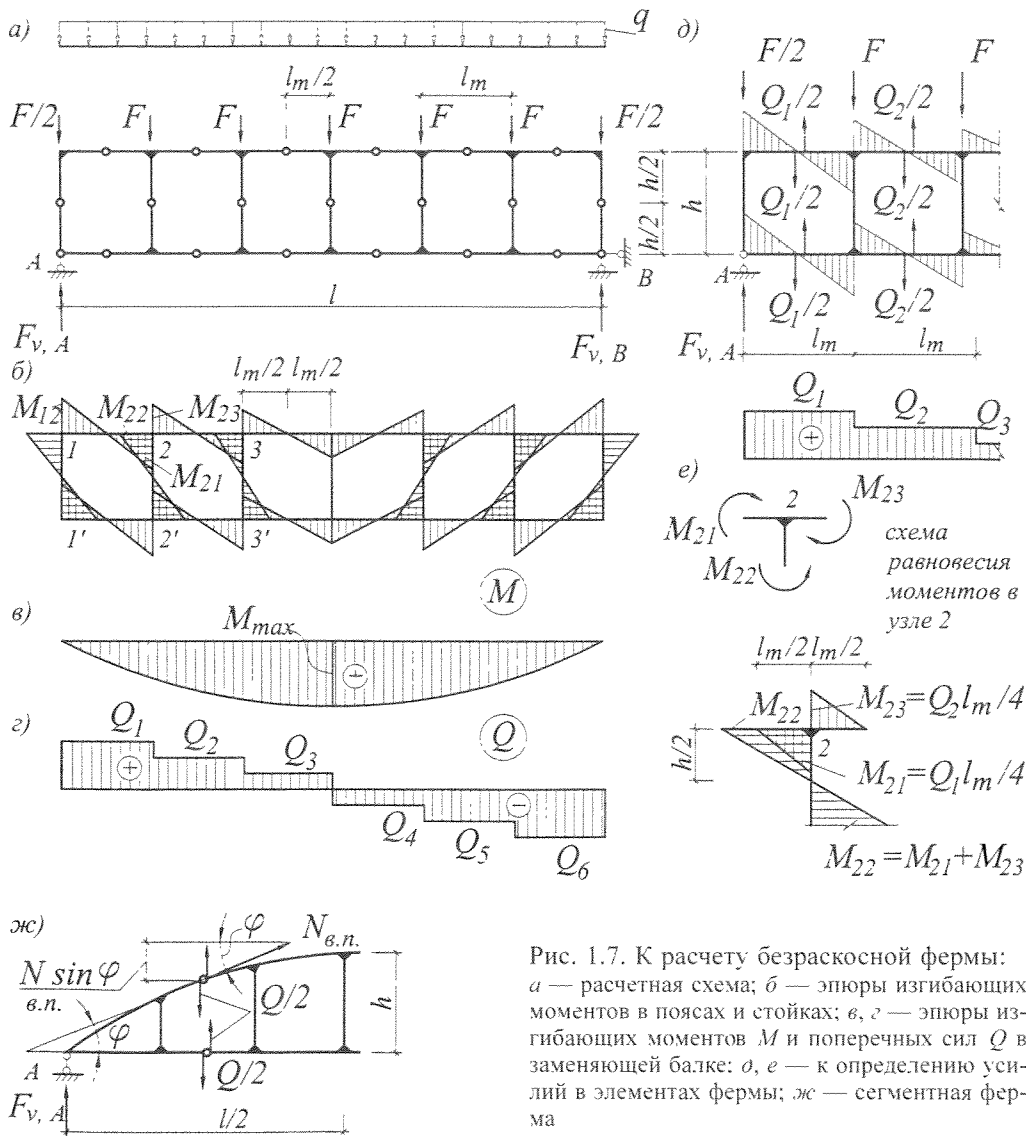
К расчету безраскосной фермы: а — расчетная схема; б — эпюры изгибающих моментов в поясах и стойках; в, г — эпюры изгибающих моментов  $M$  и поперечных сил  $Q$  в заменяющей балке; д, е — к определению усилий в элементах фермы; ж — сегментная ферма
